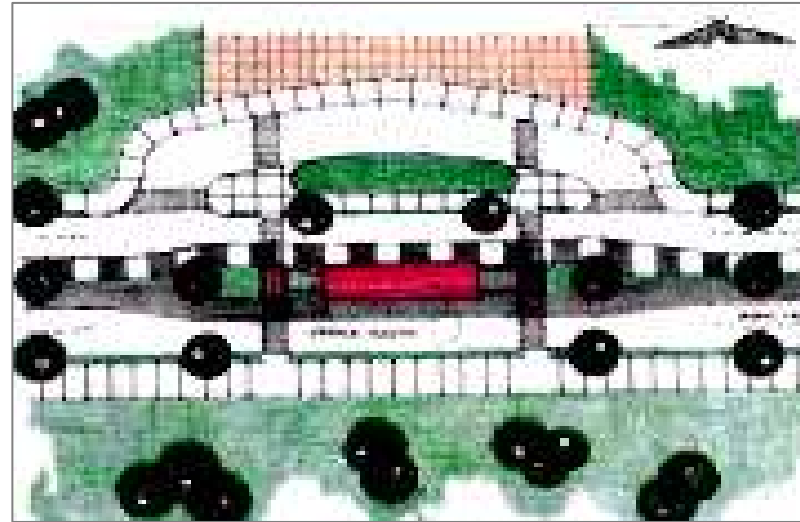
PLANTA. Propuesta de parada simple para el corredor de sectorización Pavas- San José en el sector ICE-Sabana. Fuente: O.Vega; 2002
